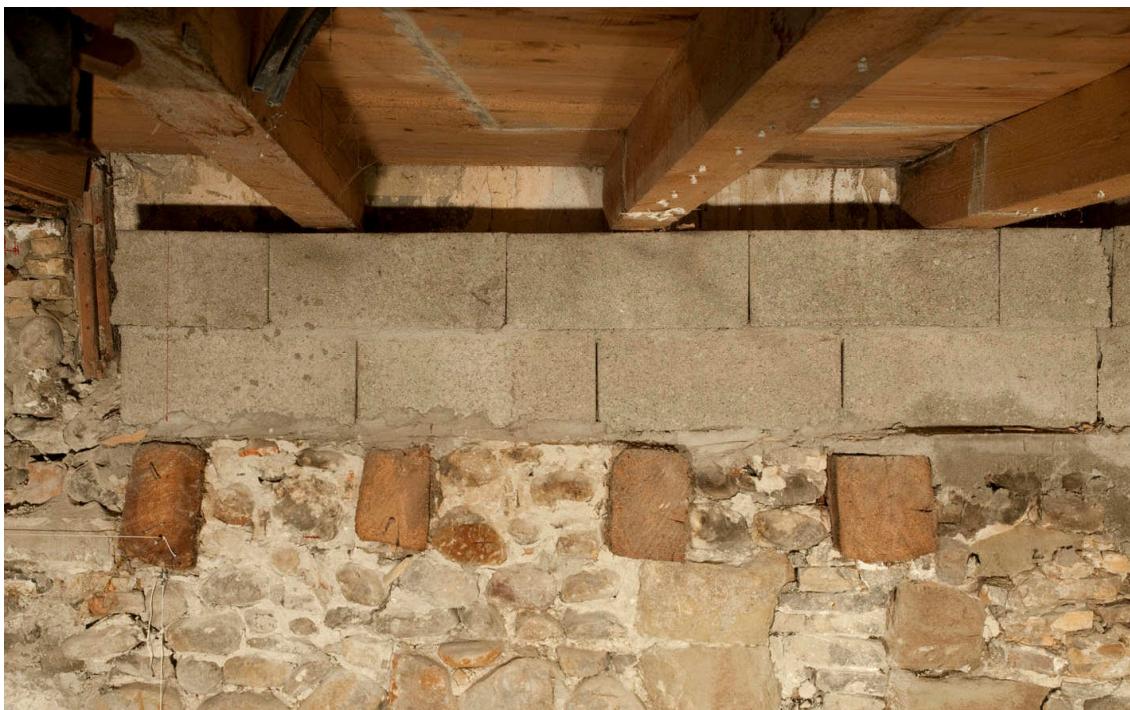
Rez-de-chaussée. Doublage de plots de ciment supportant la charpente moderne.
